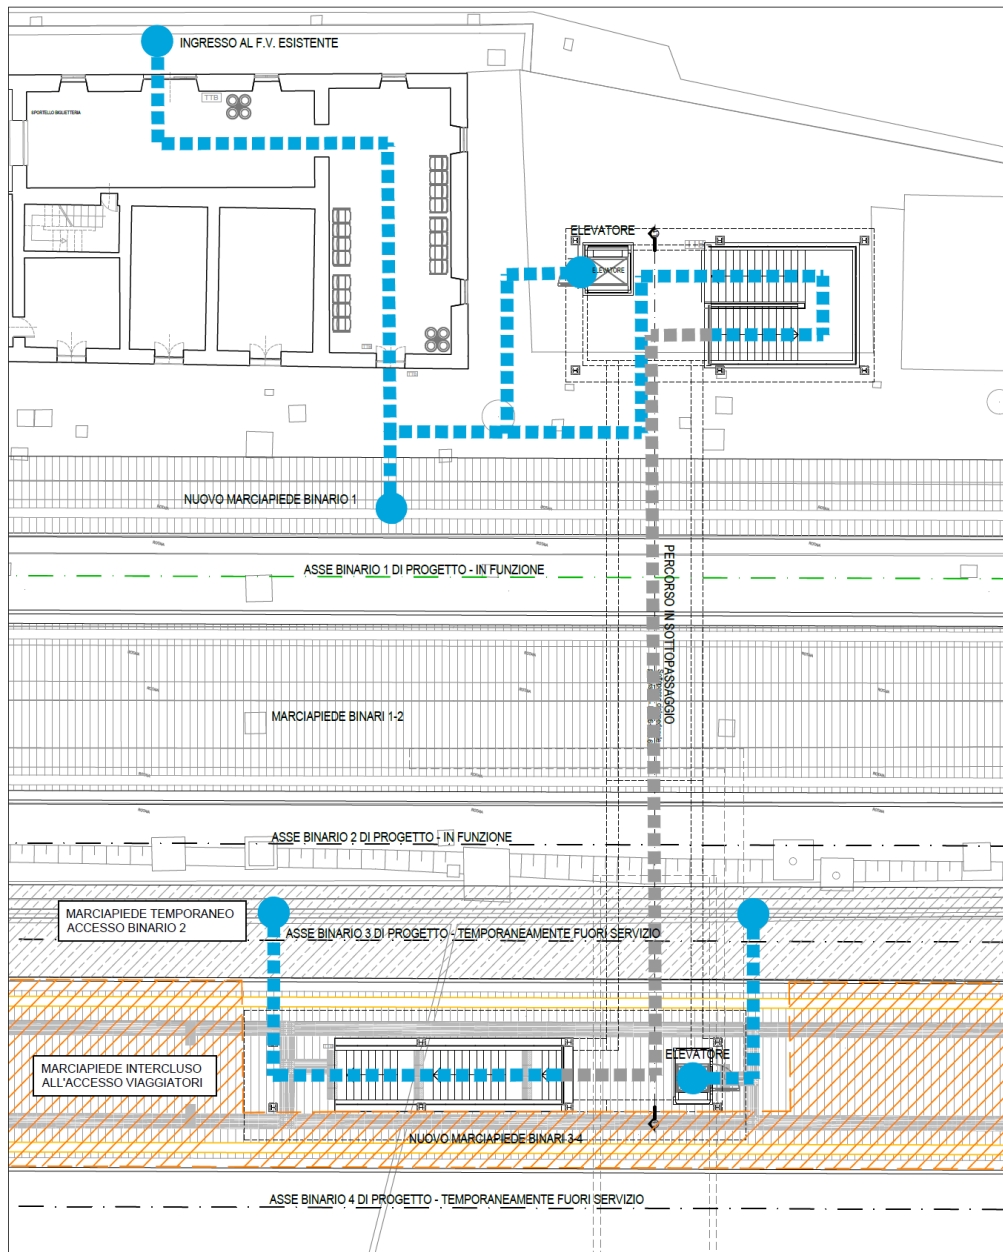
Planimetria di fase 1.3 con percorso protetto (puntinato in blu) dall'ingresso stazione al nuovo marciapiede a servizio dei nuovi binari I e II
